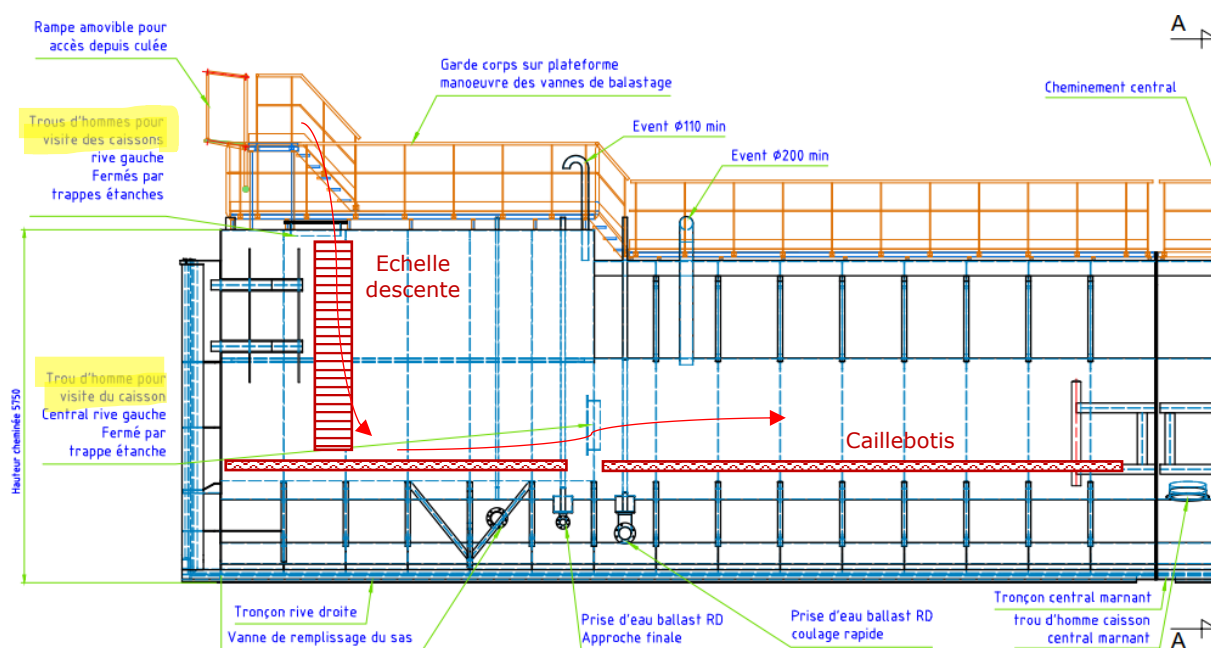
Schéma d'accès aux caissons ballastables (BT amont)
